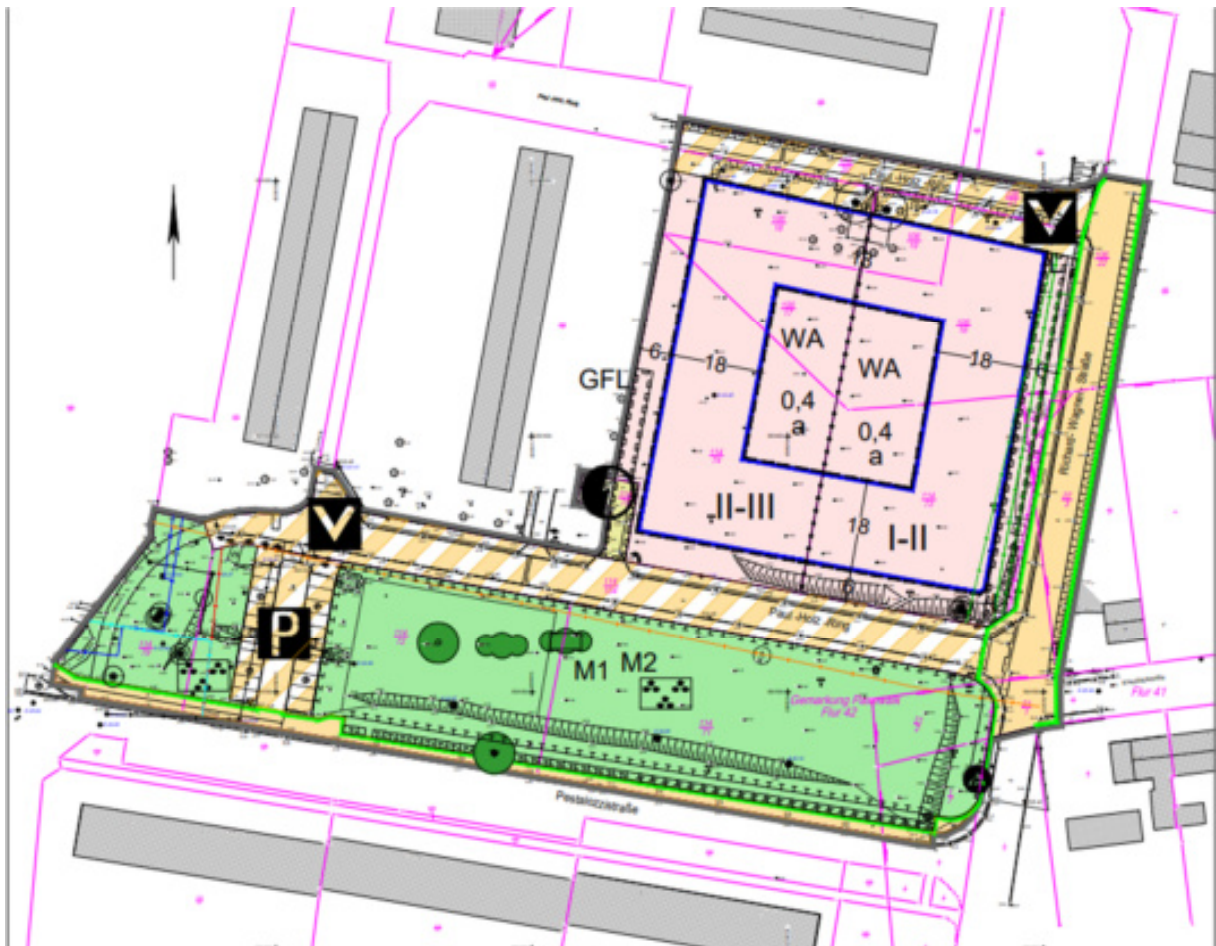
Planzeichnung Satzung B- Plan 48/18 (Quelle: Stadt Pasewalk)
